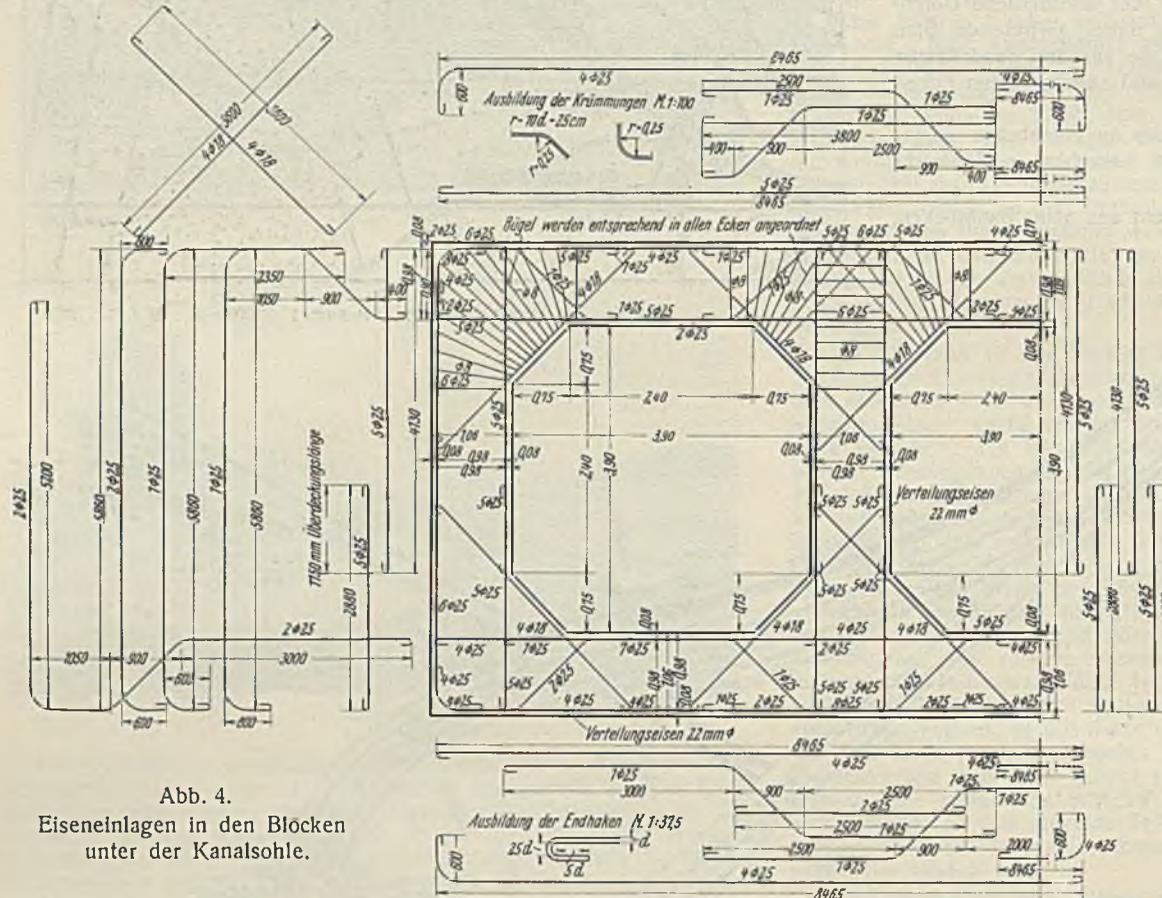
Eiseneinlagen in den Blöcken unter der Kanalsohle.
